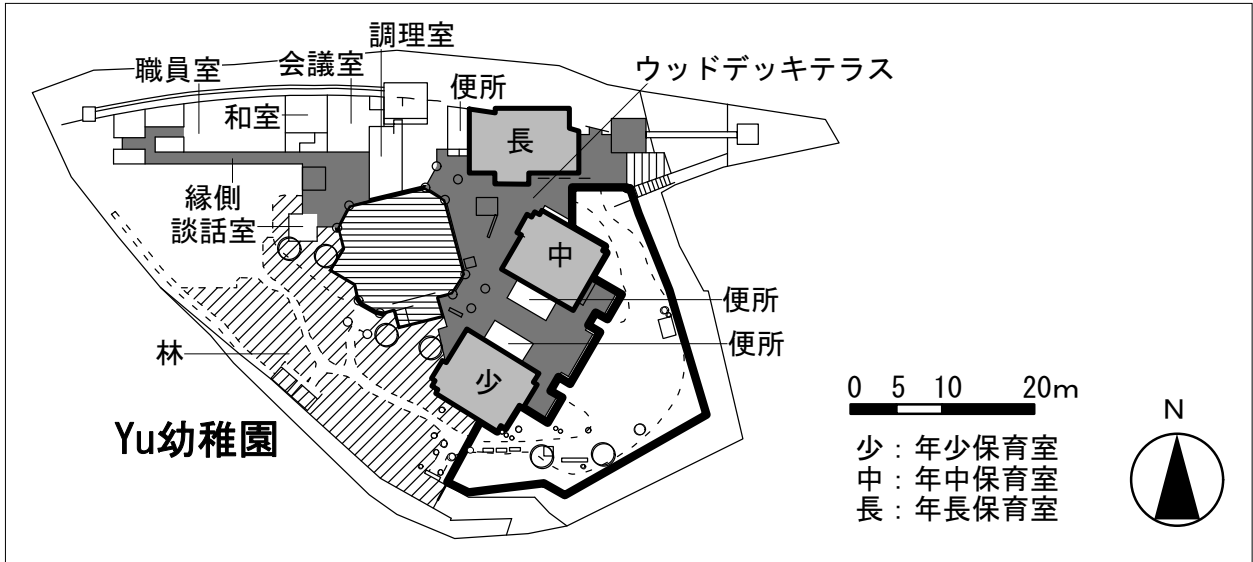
調査対象幼稚園の配置図・平面図（拡大） Yu 幼稚園
